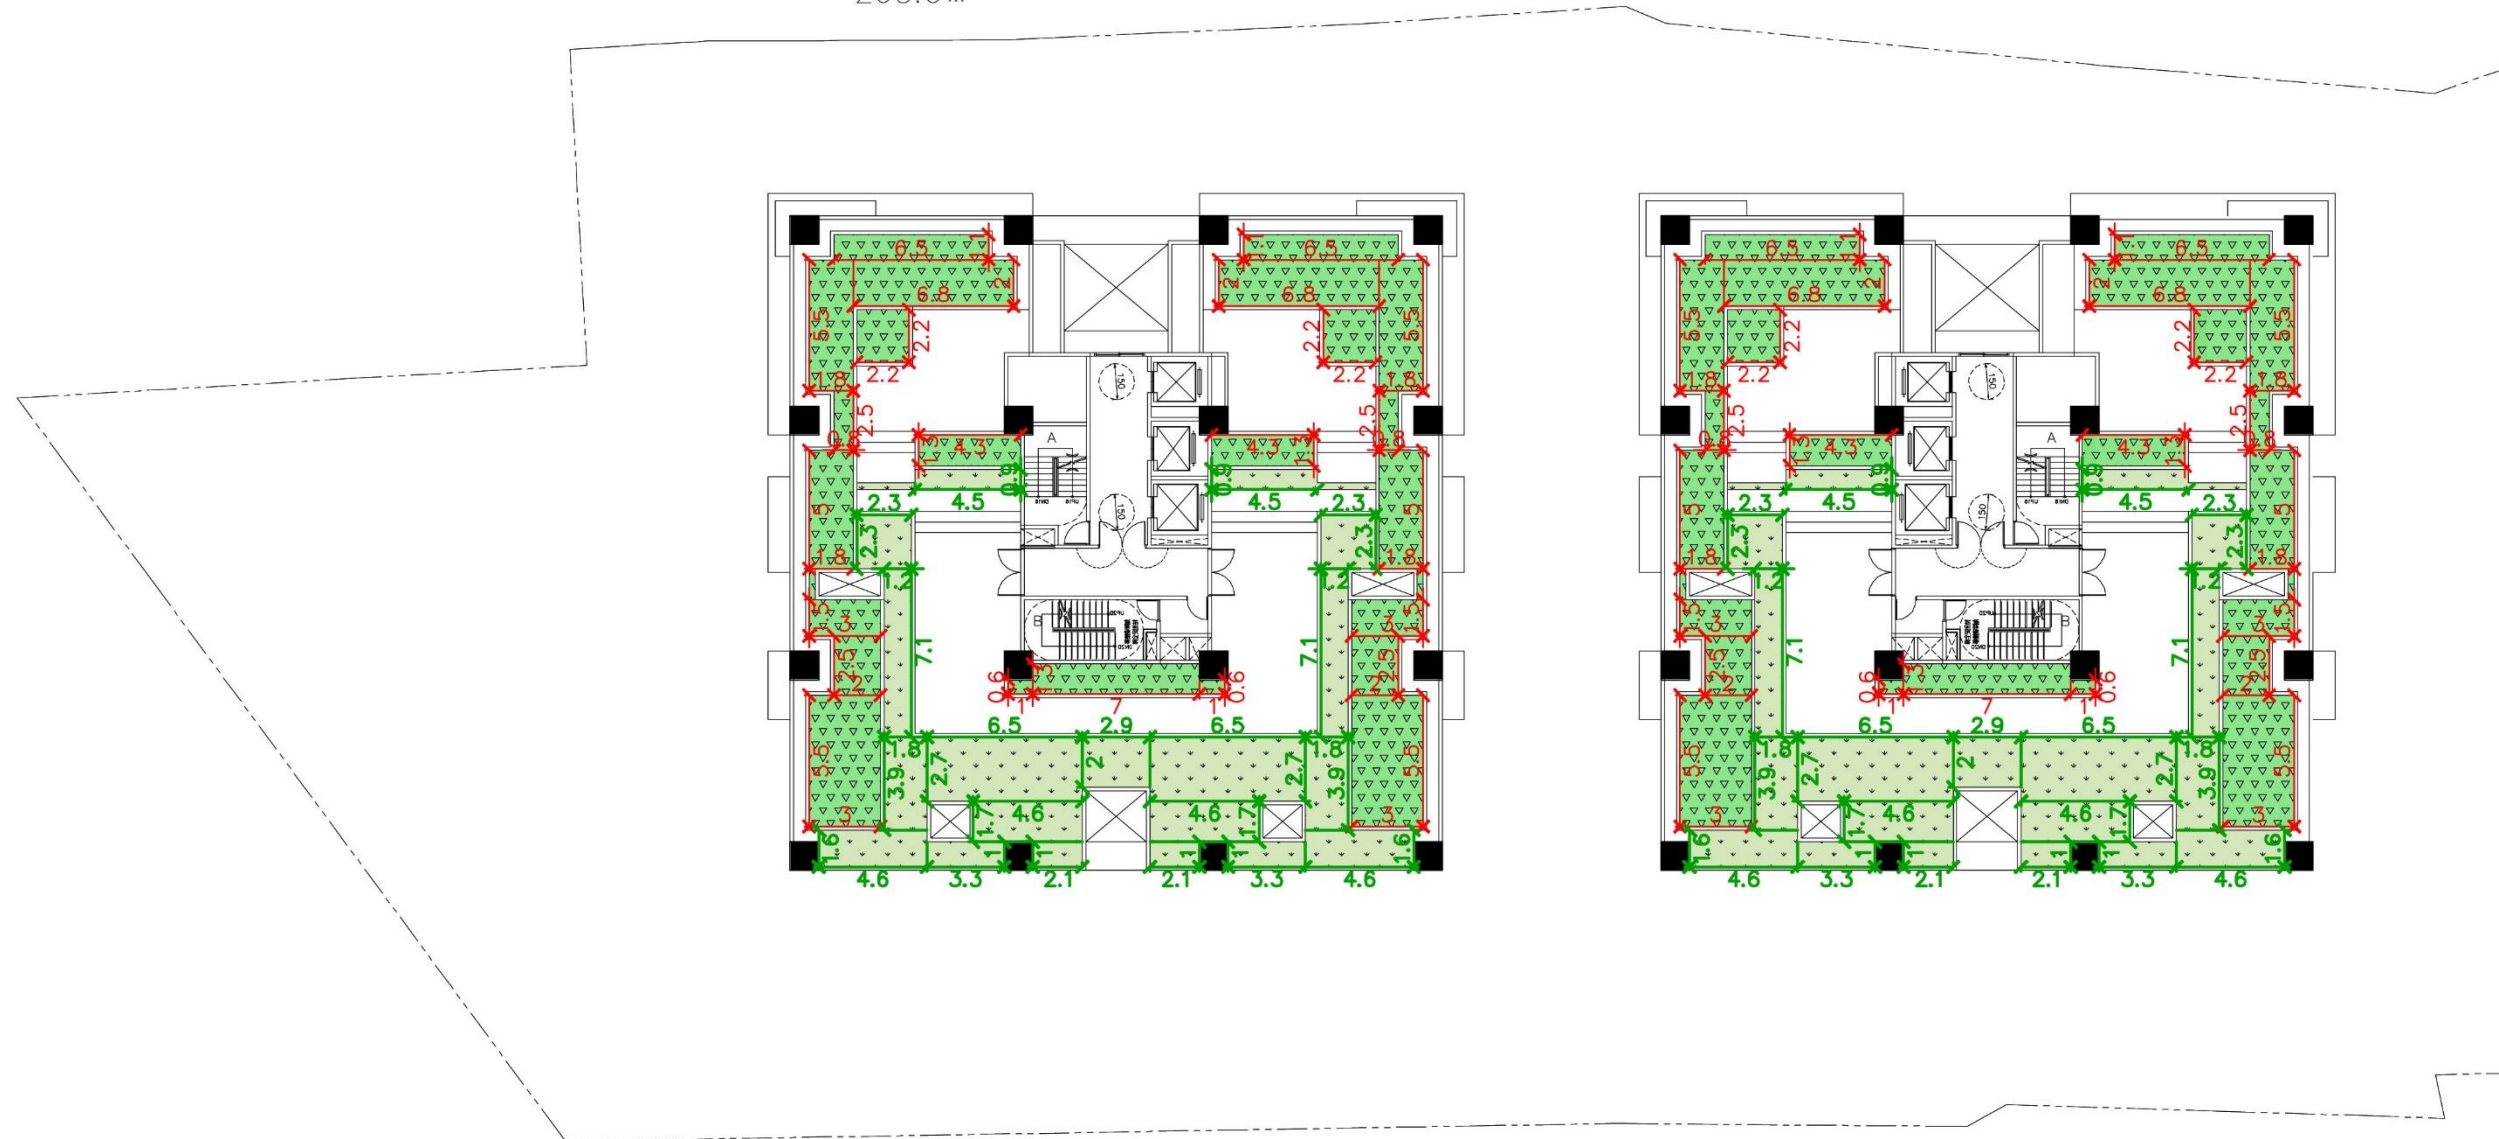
RF 露臺灌木地被計算圖說 S:1/300
